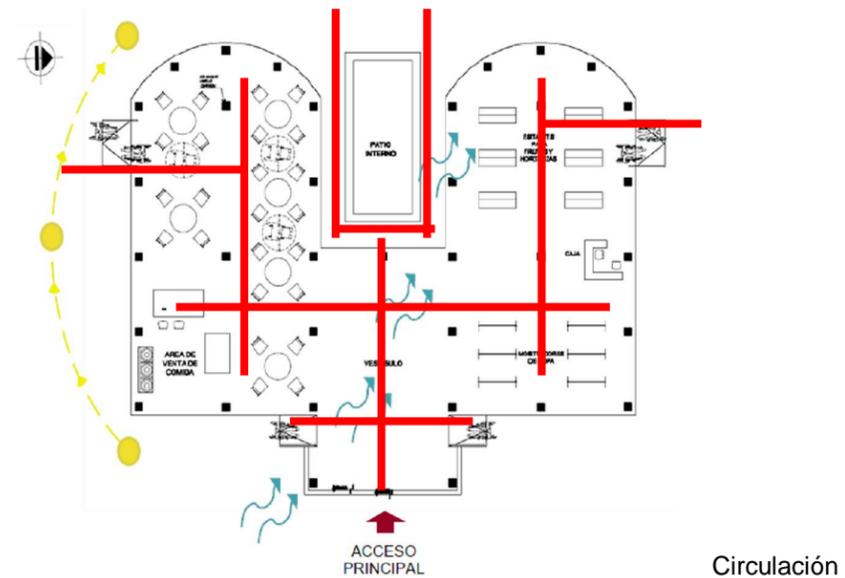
Planta de Salón de Kermes propuesta./ Fuente: Propia
